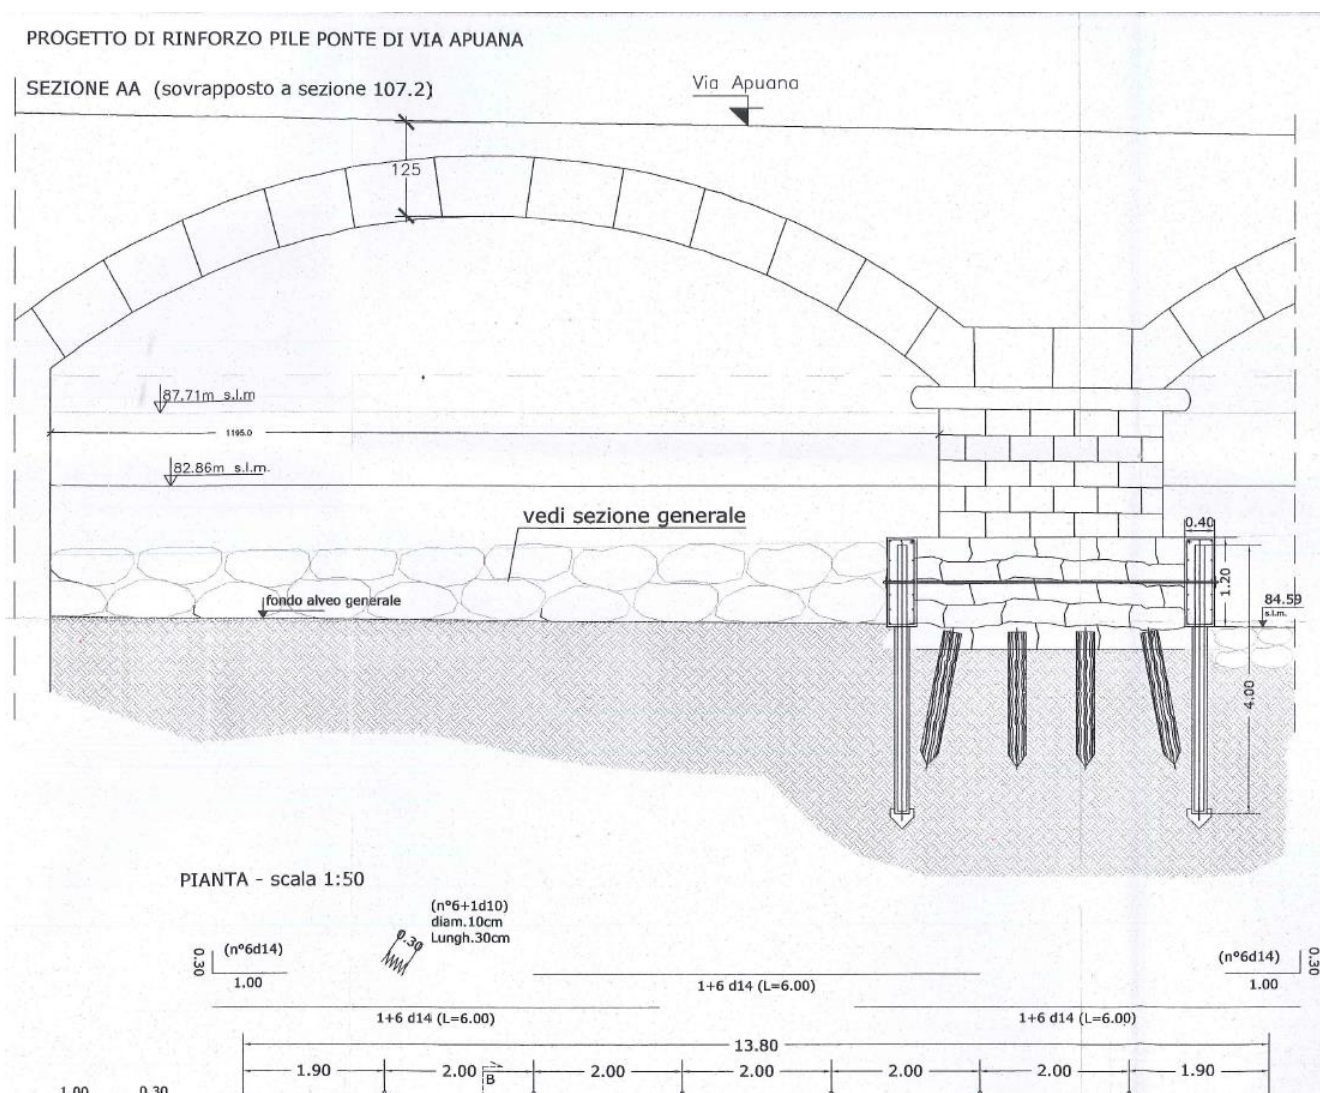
Consolidamento Pila e Spalle Ponte via Apuana – Estratto Pratica Sismica N. 44/2010 + varianti
